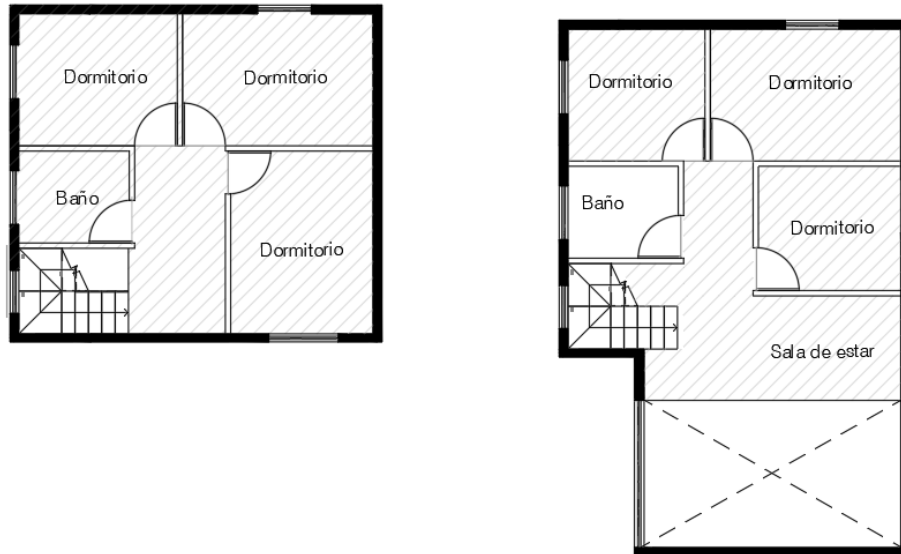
Configuración en planta segundo piso. Fuente: Elaboración Propia.
